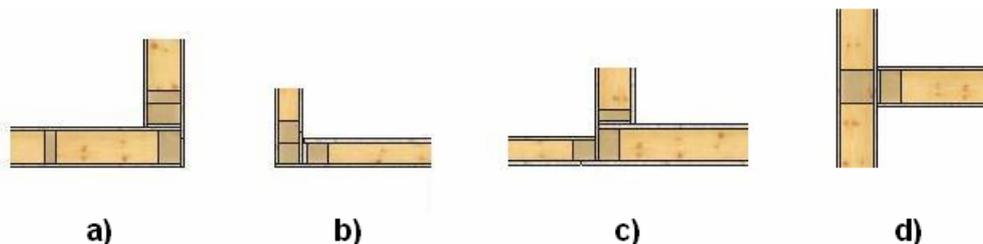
Wandanschlüsse Gebäudemodell 1 – a) und b) Außenecken, c) Innenecke d) T-Stoß
